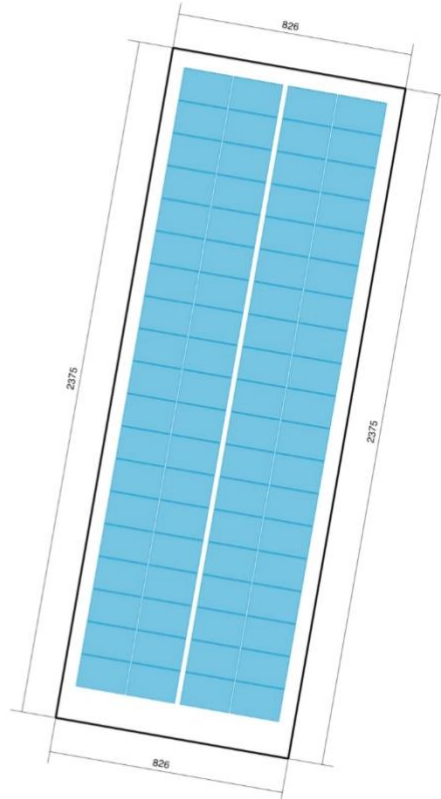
Bürgerfeldstrasse 2.1, Belegungsplan, Dachfläche 2
